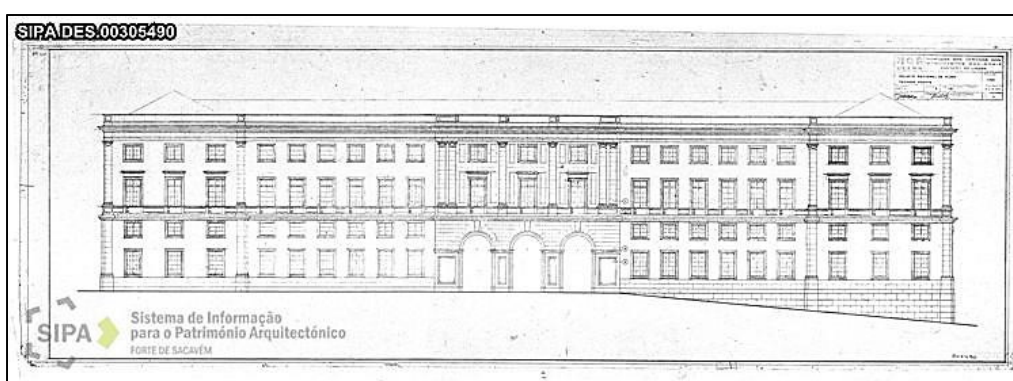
Fachada Poente, Projeto de João Seabra, de 1977.
